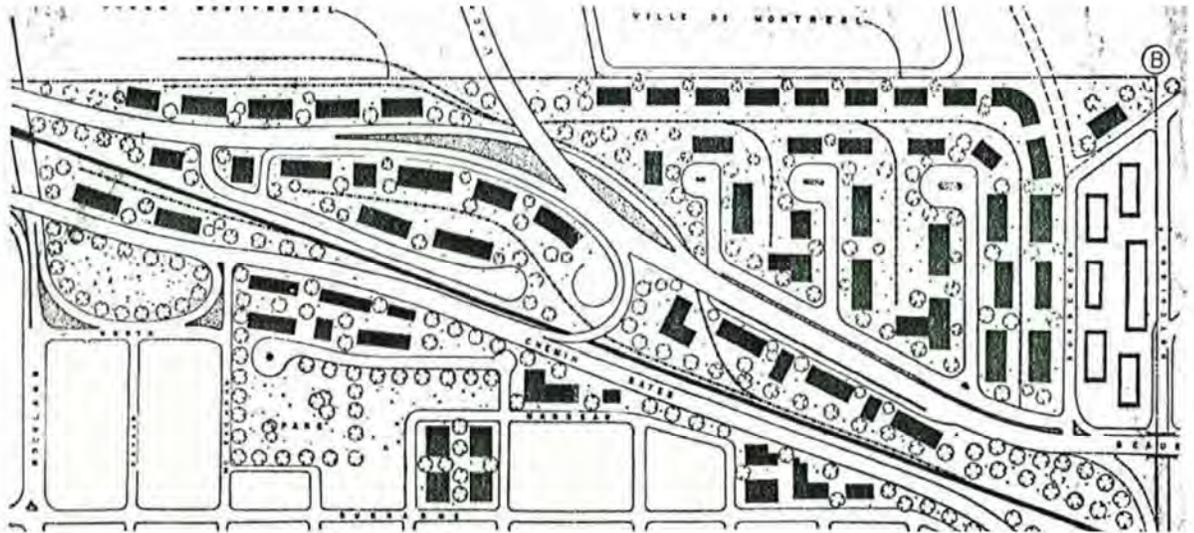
Projet de redéveloppement urbain mixte sur la gare de triage (1982)
